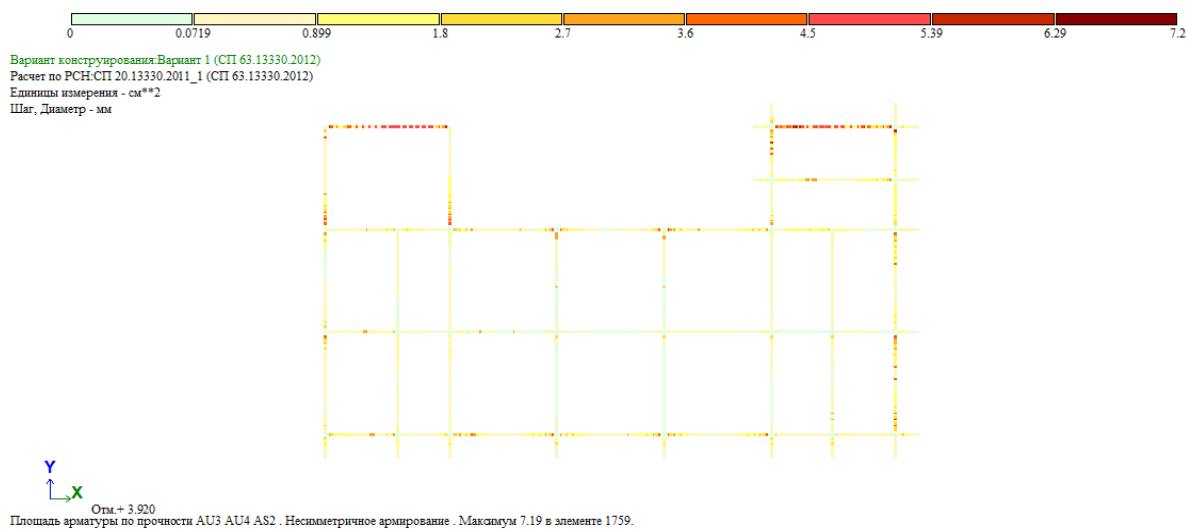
Площади требуемого армирования балок (верхняя зона)
